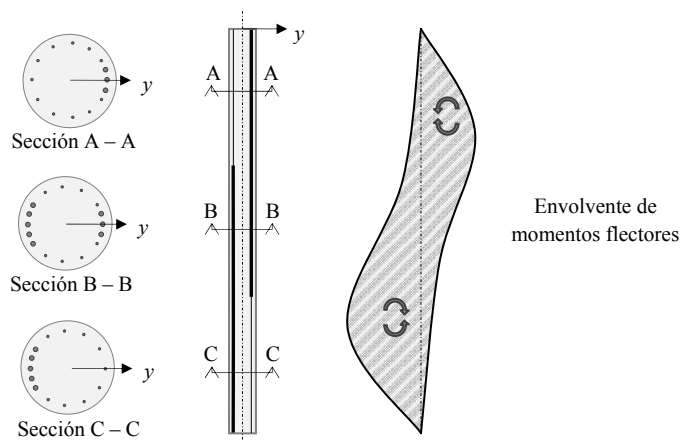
Pilote armado asimétricamente con varios niveles de armado distintos en su longitud
